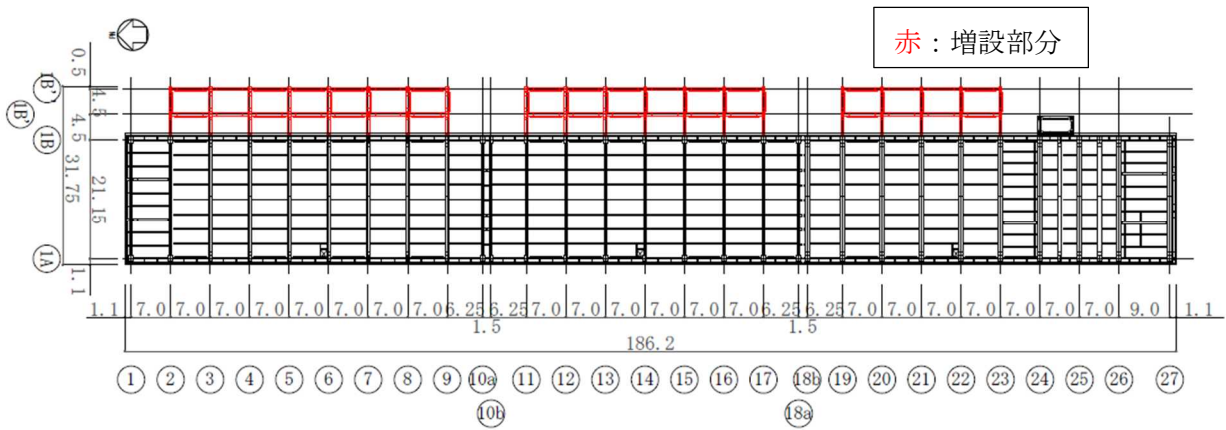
(3) 2 階平面図 (G. L. +16.650) (単位 : m)
